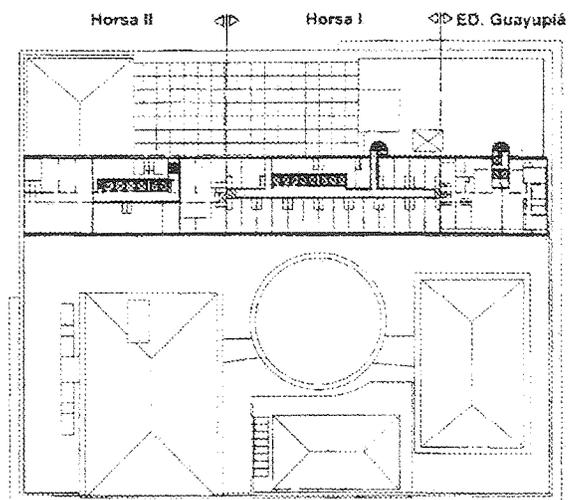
Conjunto Nacional, David Libeskind, São Paulo. Planta atual.
